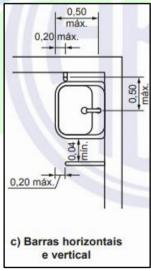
Dimensões para instalação das barras de apoio para lavatório conforme NBR 9050/2020
